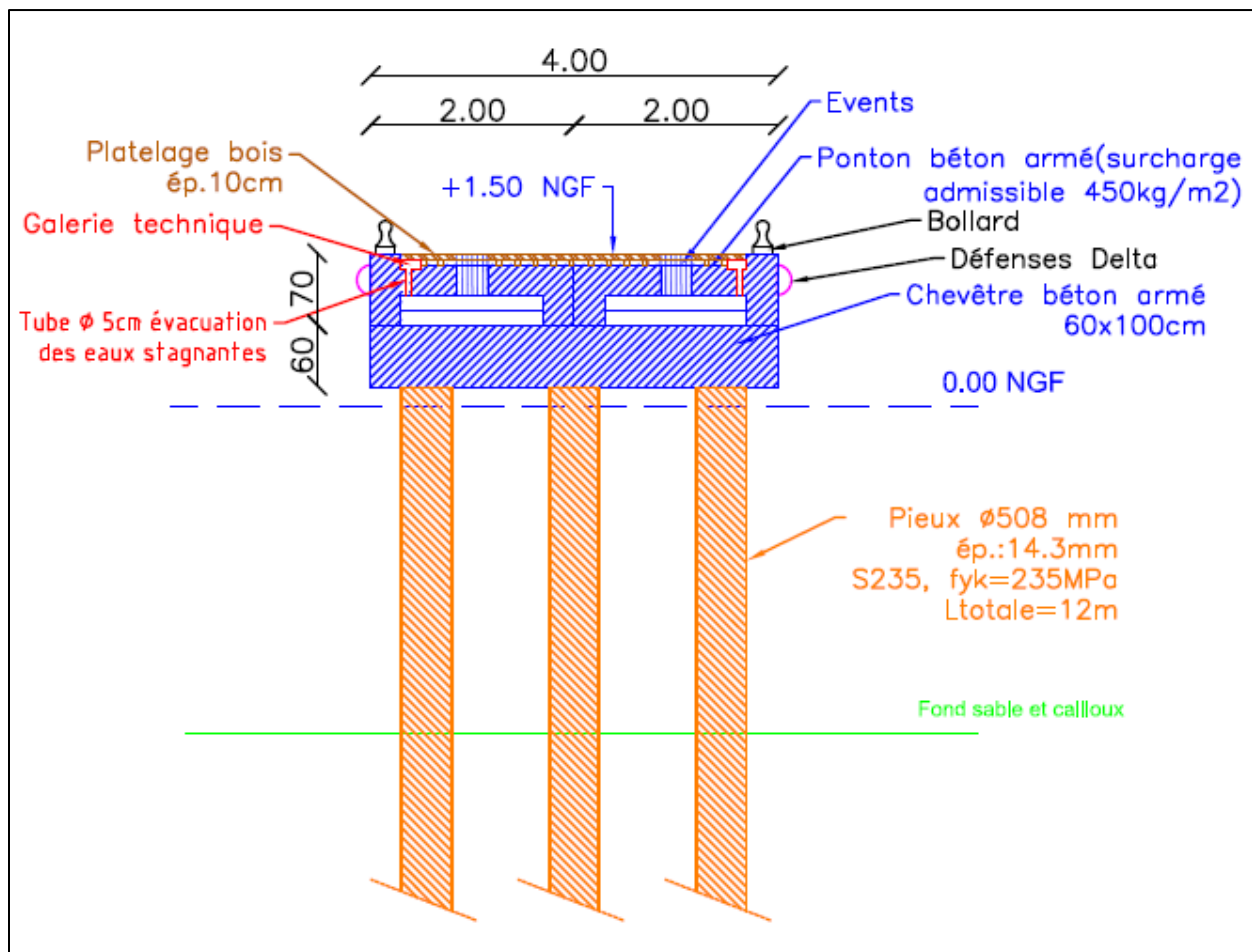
Coupe type transversale du ponton lourd central prévu Plage de la Nartelle
